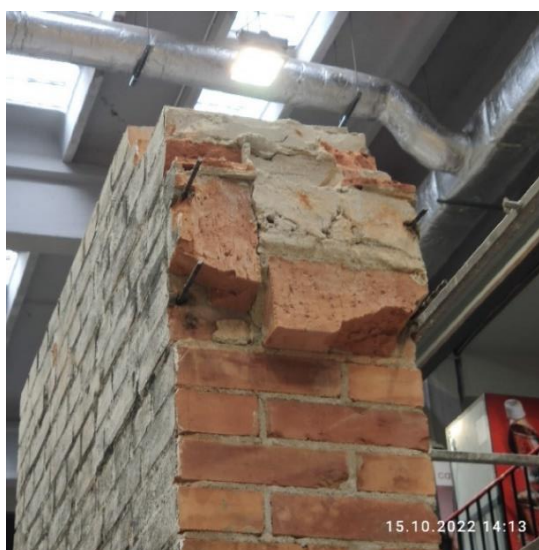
Widok fragmentu łuku nadproża elementu badawczego C.2-1 w trakcie badania
